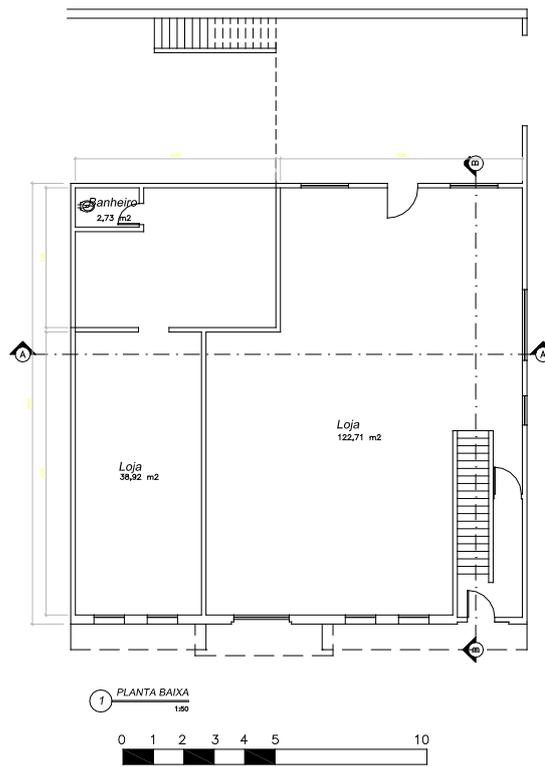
Planta pavimento térreo - Casa Anna Acha Ayub
